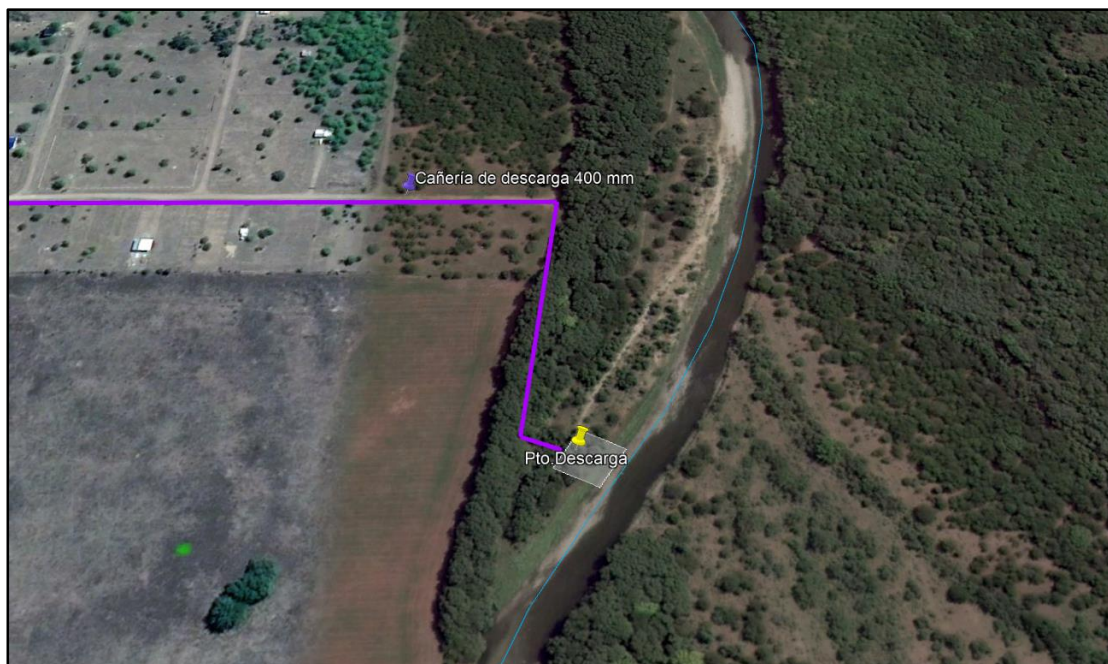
EMPLAZAMIENTO DEL PUNTO DE DESCARGA SOBRE EL RÍO SANTA ROSA.
